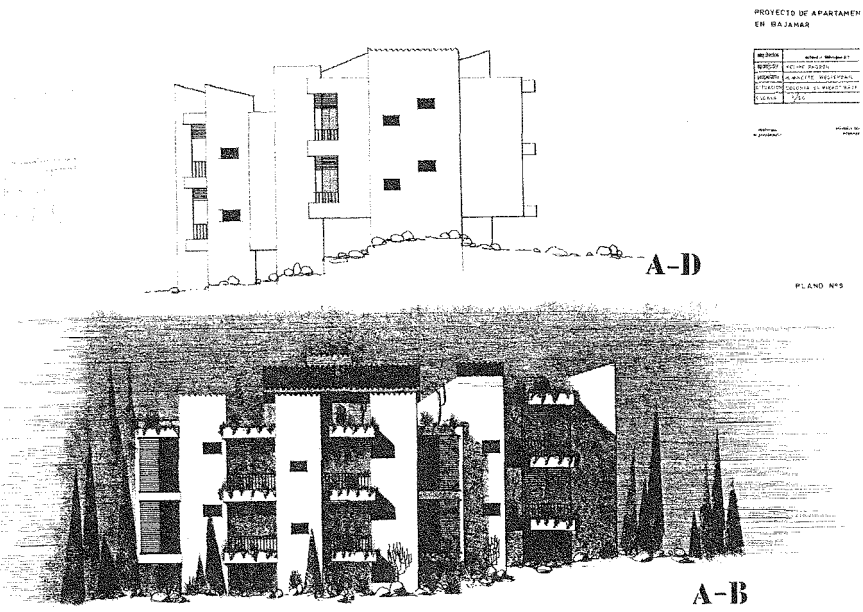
S. Fábregas: Plano n.º 9. Alzado de fachadas. Proyecto de apartamentos en Bajamar, Tenerife, 1963 (Archivo Fábregas).
